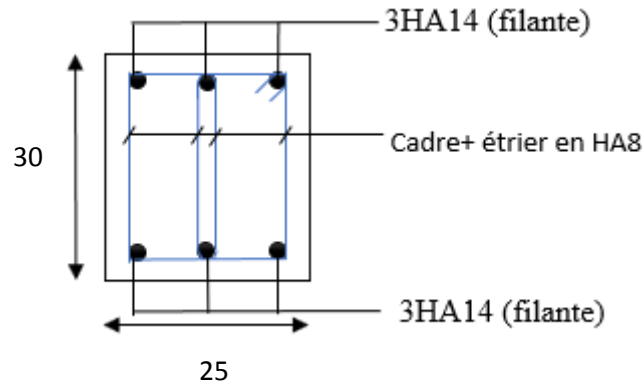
Ferrailage sur appui de la poutre principale
